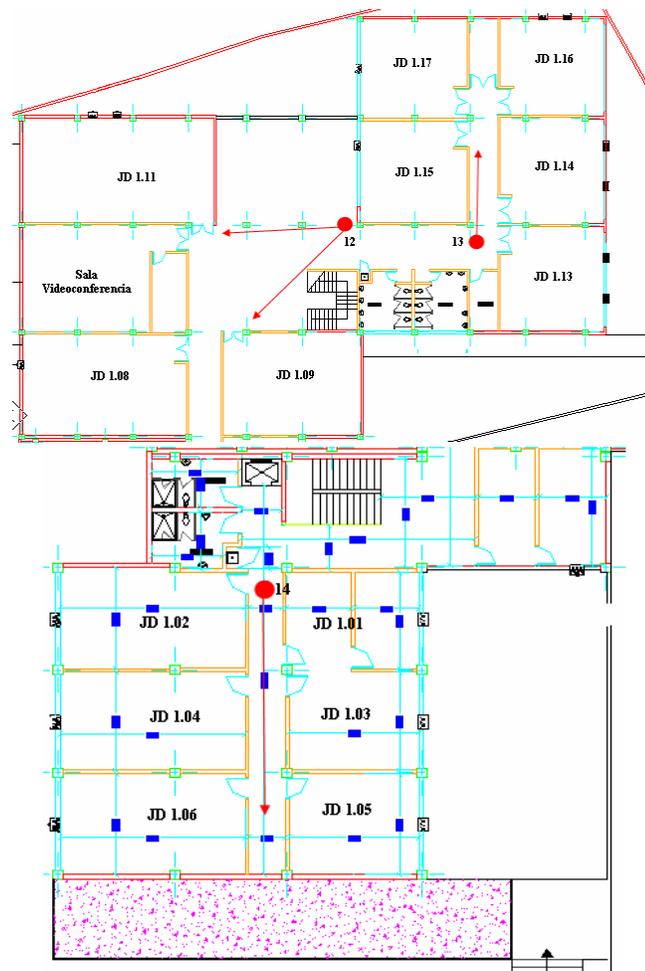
Ubicación de cámaras edificio Jan Deketh piso 1
